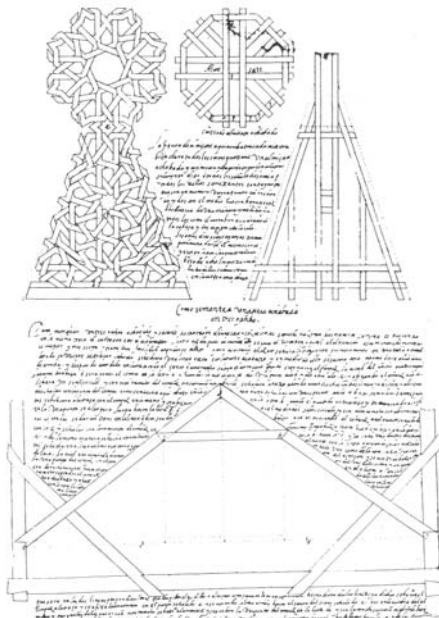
Reglas alta y baja, y lazo para una armadura ochavada. Lámina LVIII.²⁴³
